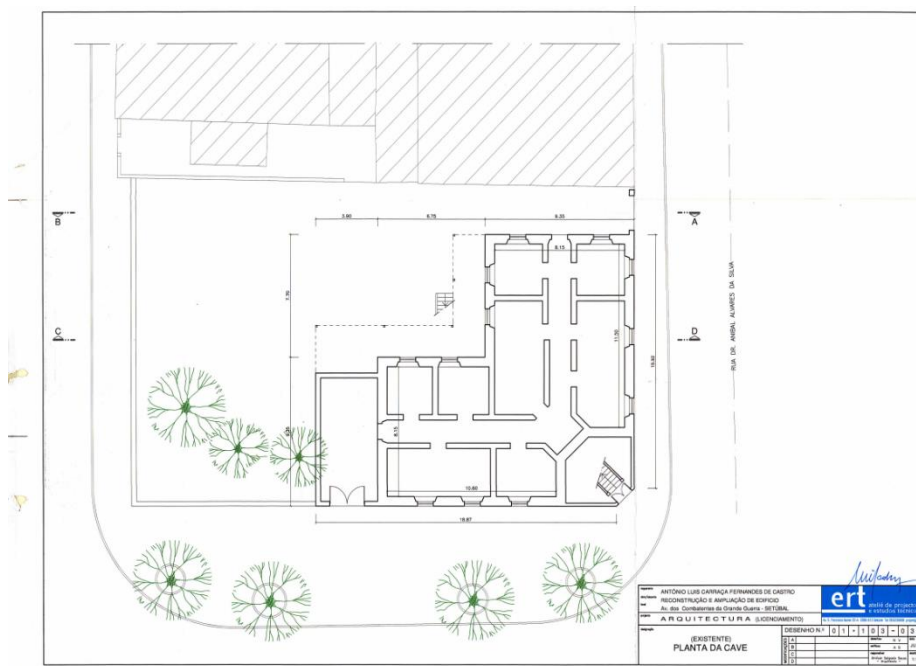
Desenho técnico da planta da cave. Fonte: ERT
